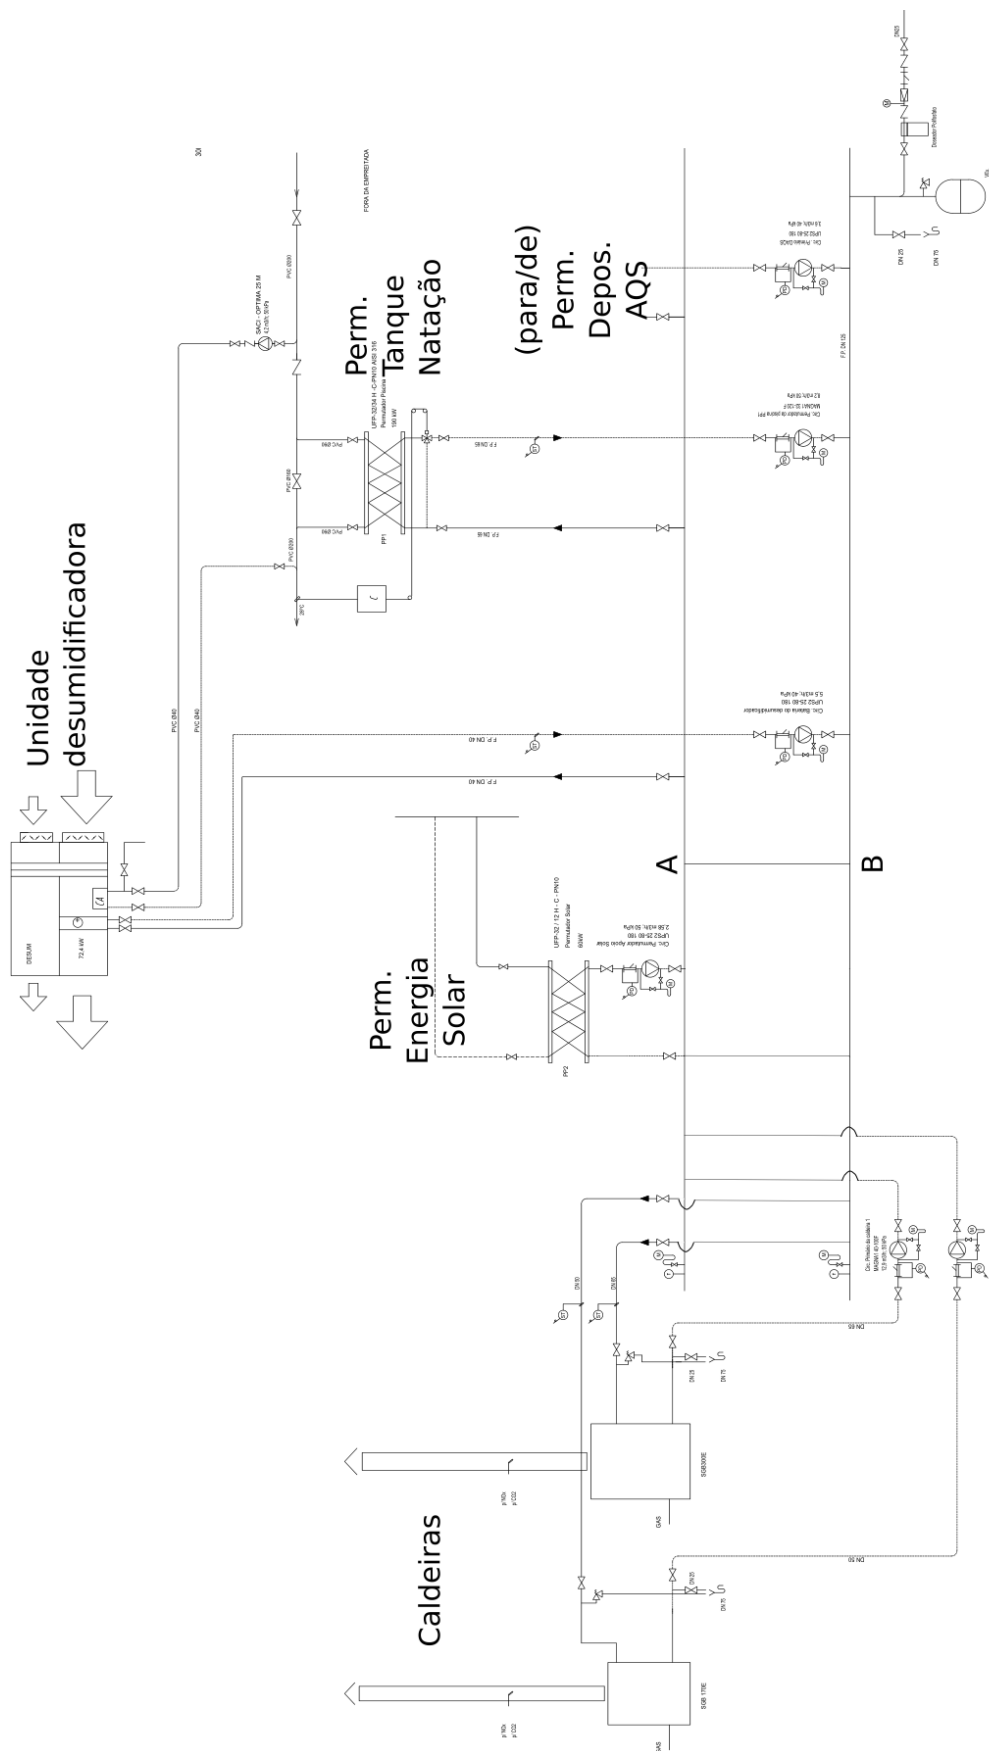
Pormenor de rede hidráulica instalada. Conjunto distribuidor coletor (adaptação de tela final).
